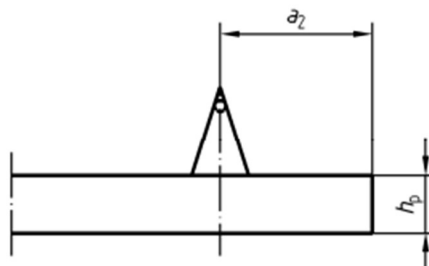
distanza tra la trave più esterna ed il bordo della piastra
